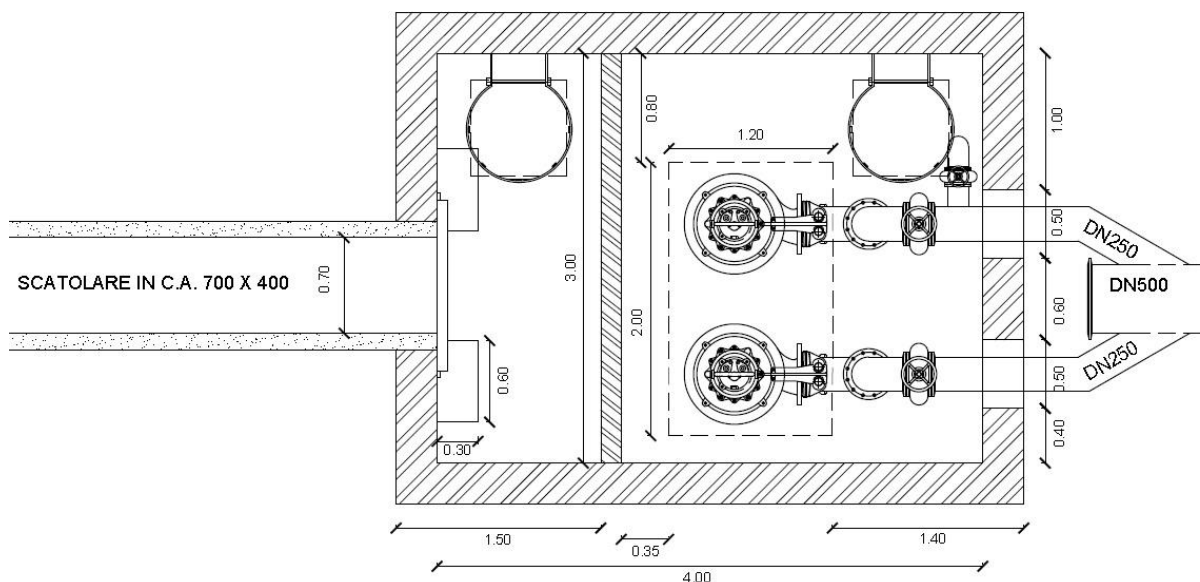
Stazione di sollevamento 'Passo della Sentinella': pianta del pozzetto di carico.
